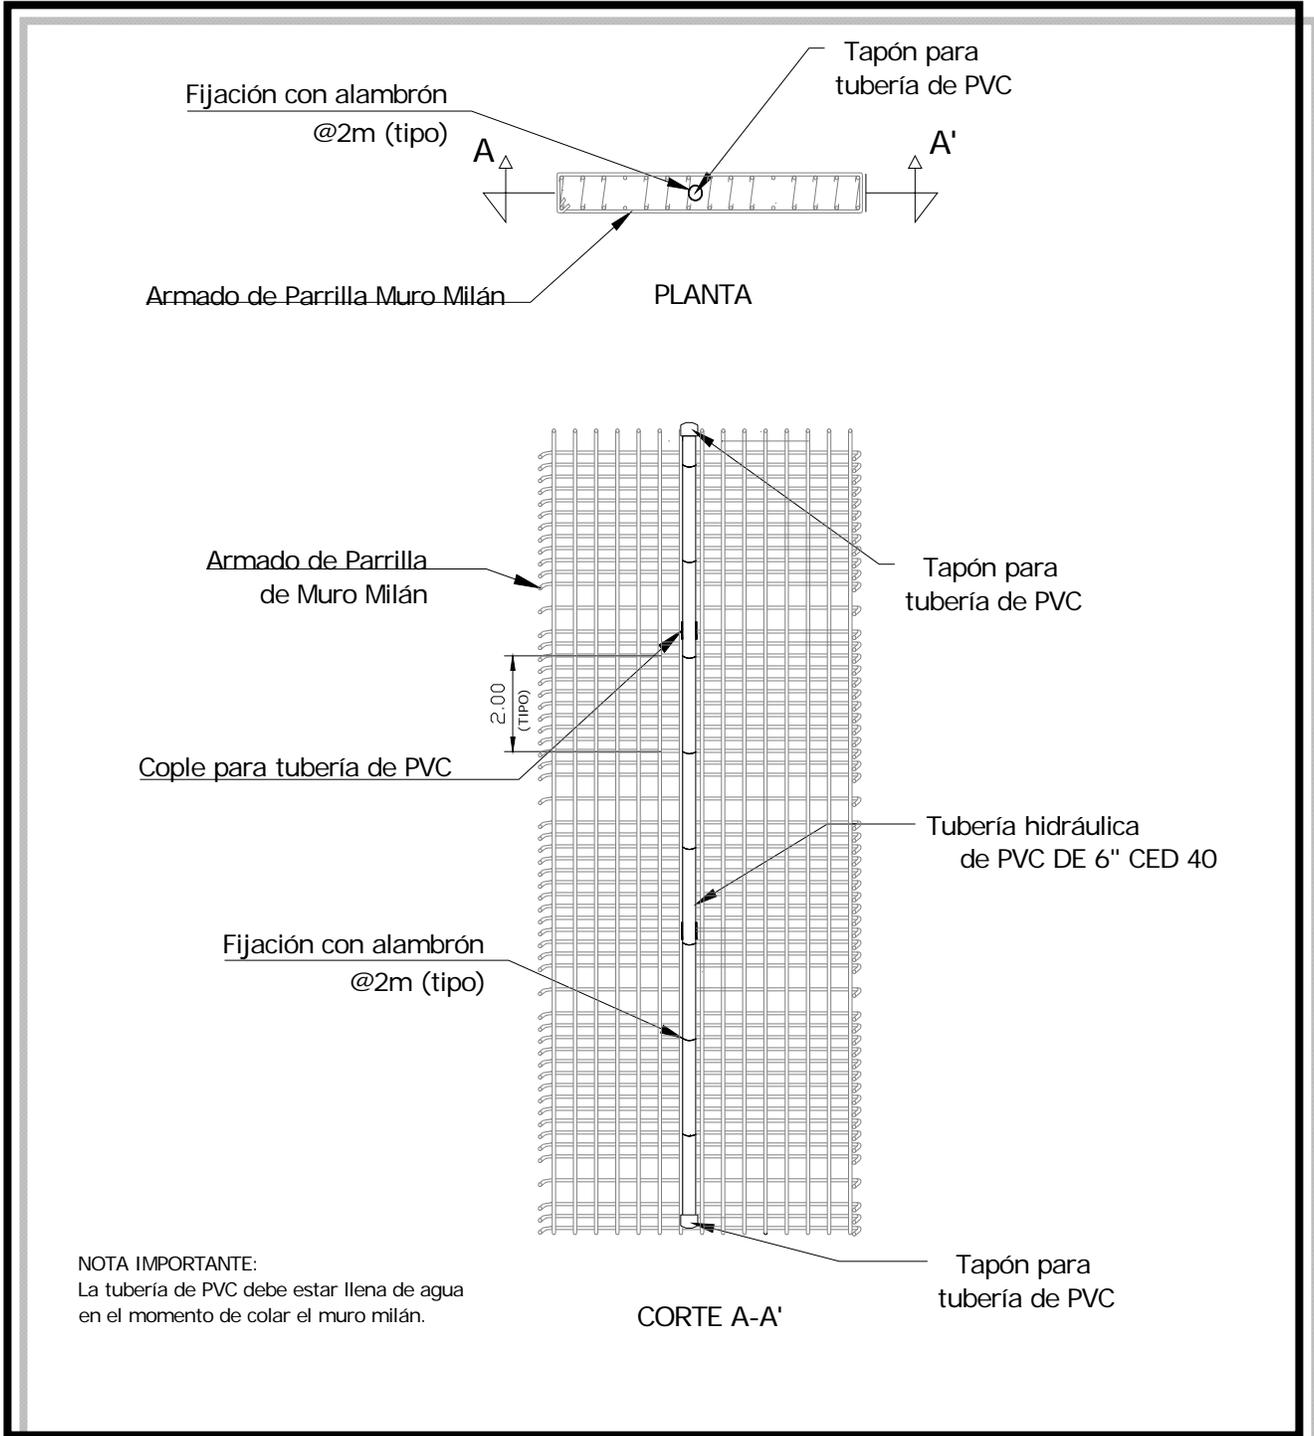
Instalación de inclinómetro en muro Milán
